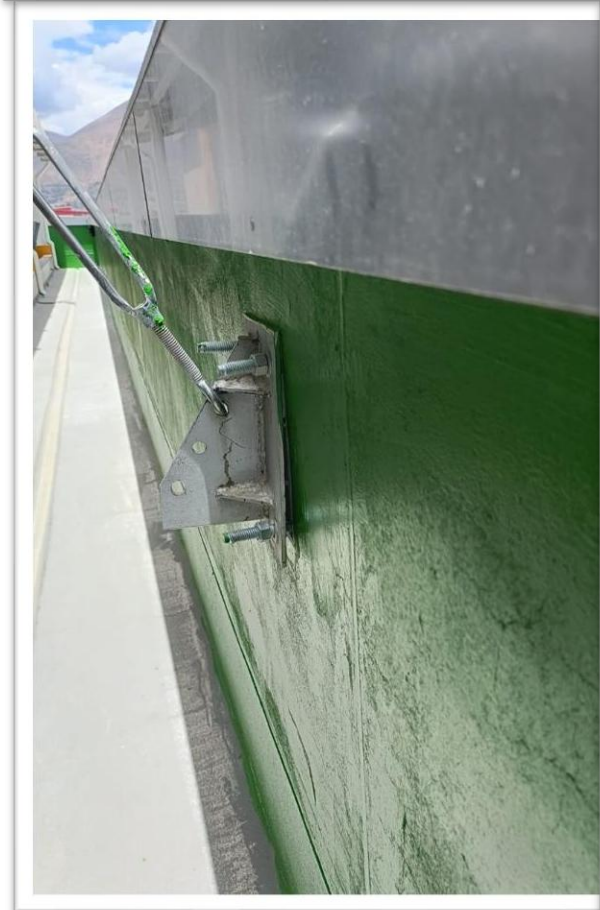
Ganchos de anclaje de la cobertura metálica sujetos a parapetos que se encuentran expuestos a desprenderse.
